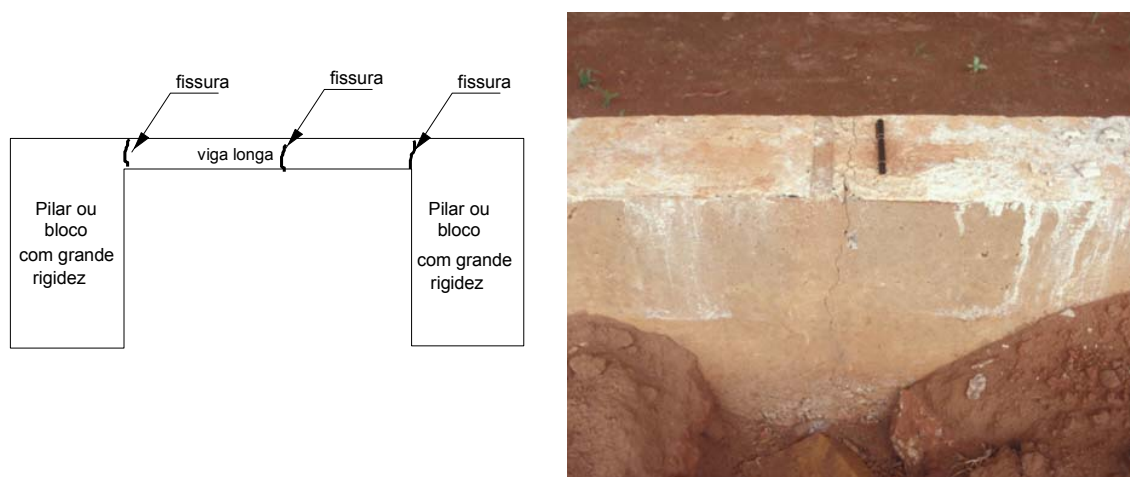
Fissura de retração na ligação entre viga e pilar de inércias muito diferentes
